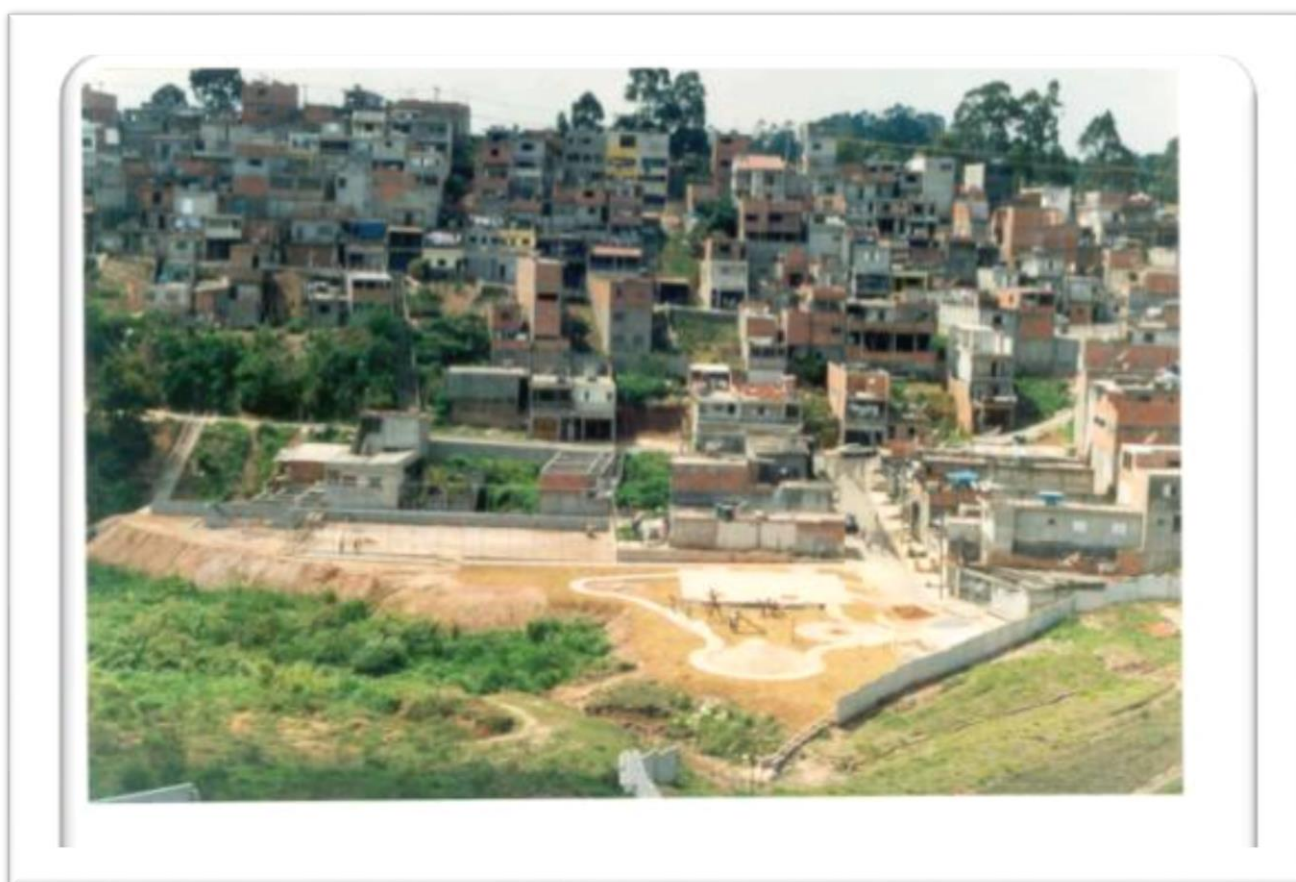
Ocupação ao longo do traçado do Rodoanel Mário Covas com infraestrutura recente – trecho Anhanguera – Bandeirantes – lote 6.
